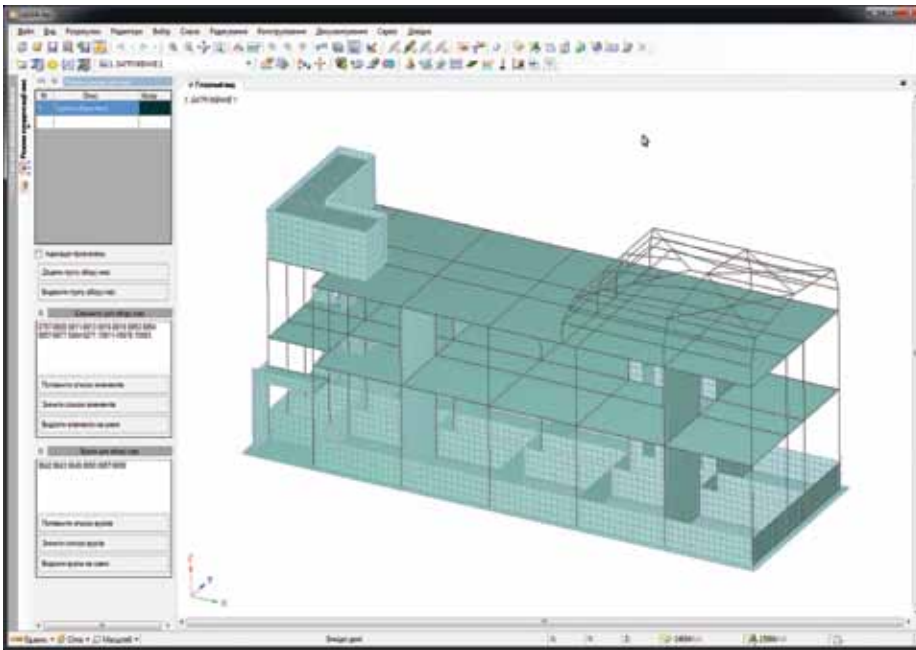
Розрахункова схема жорсткої будівлі із закріпленням на ній гнучким металевим каркасом
